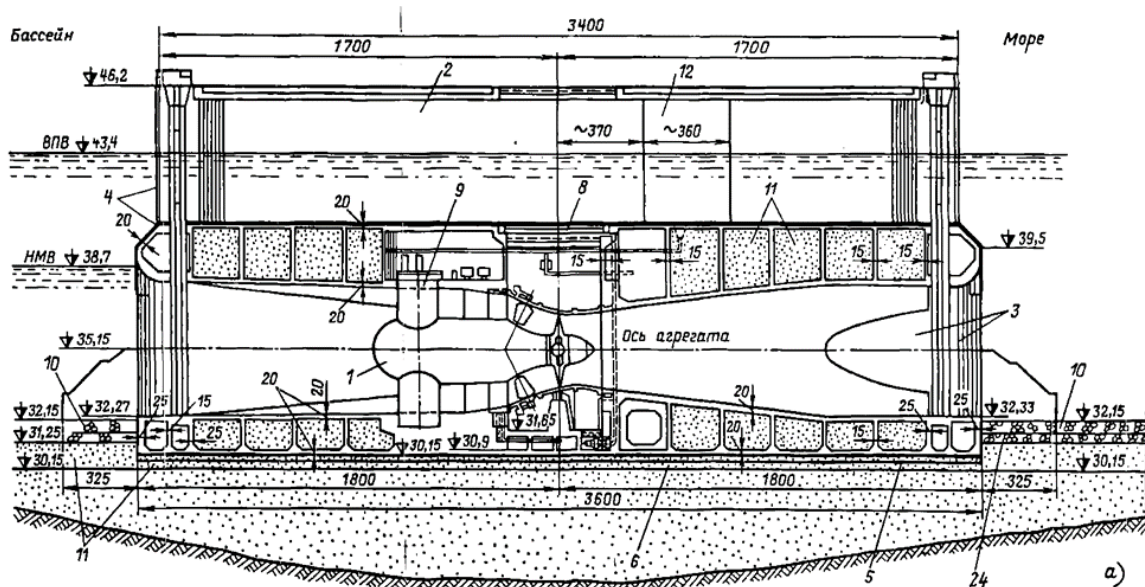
Продольный разрез наплавного блока по оси агрегата [2, с. 244]
